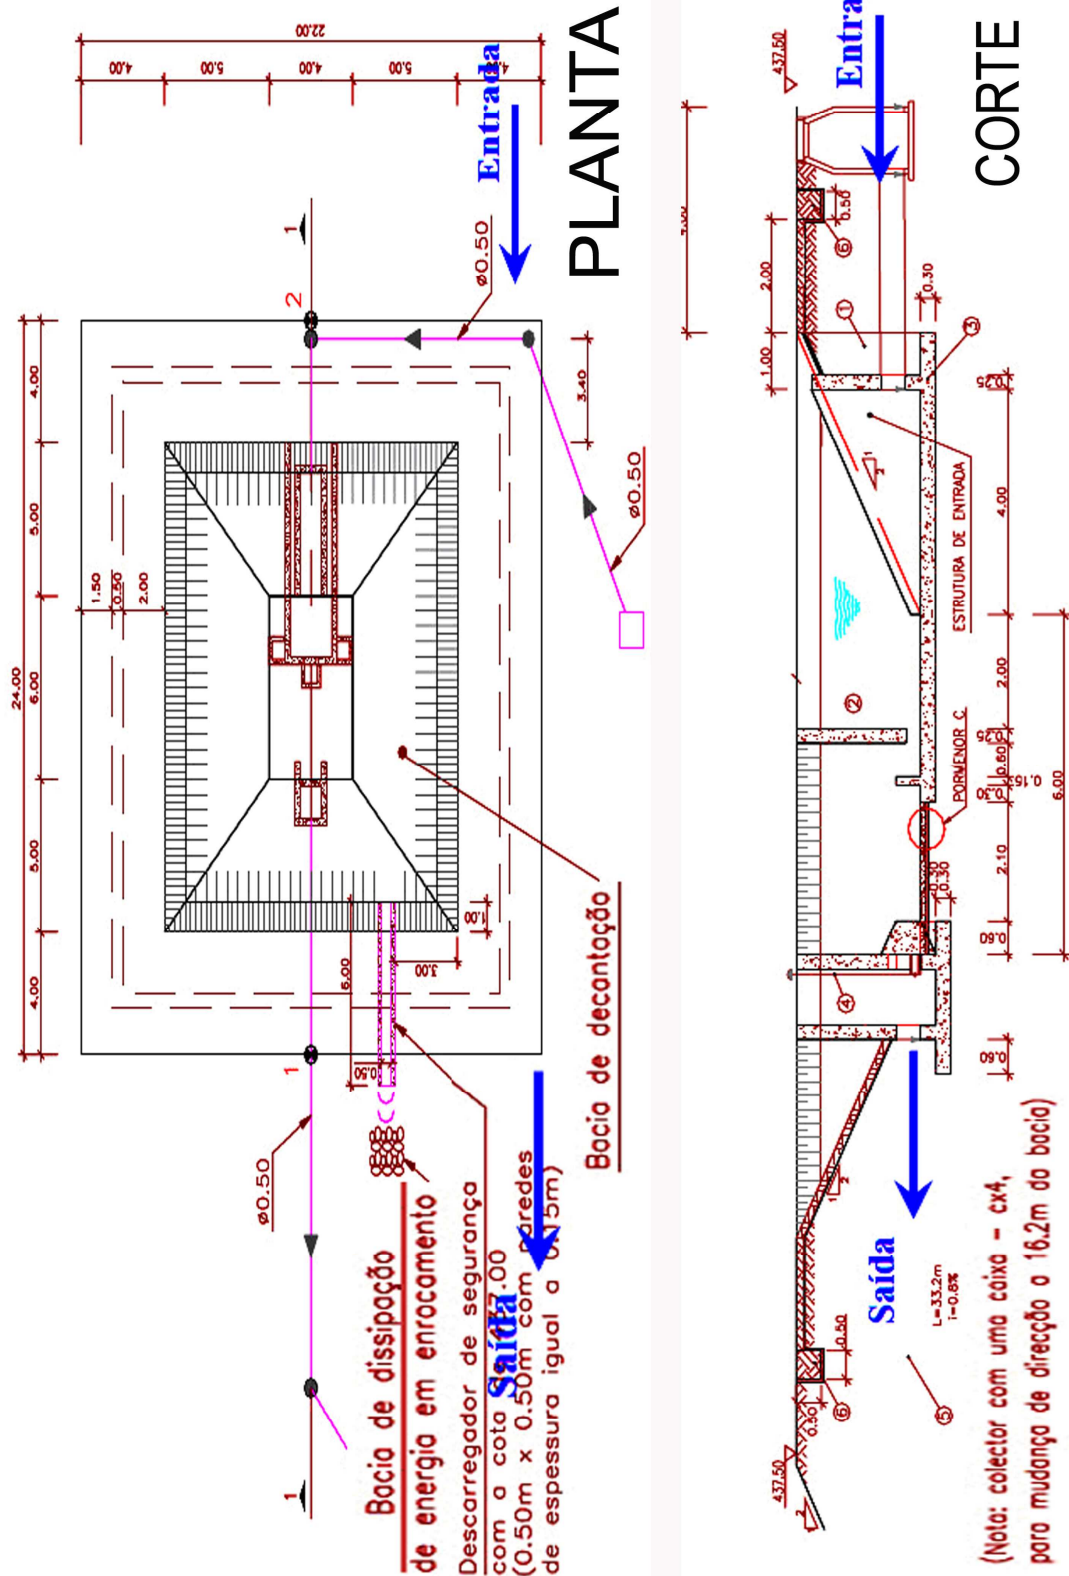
Bacias de decantação Covilhã Norte, Planta e Corte.
